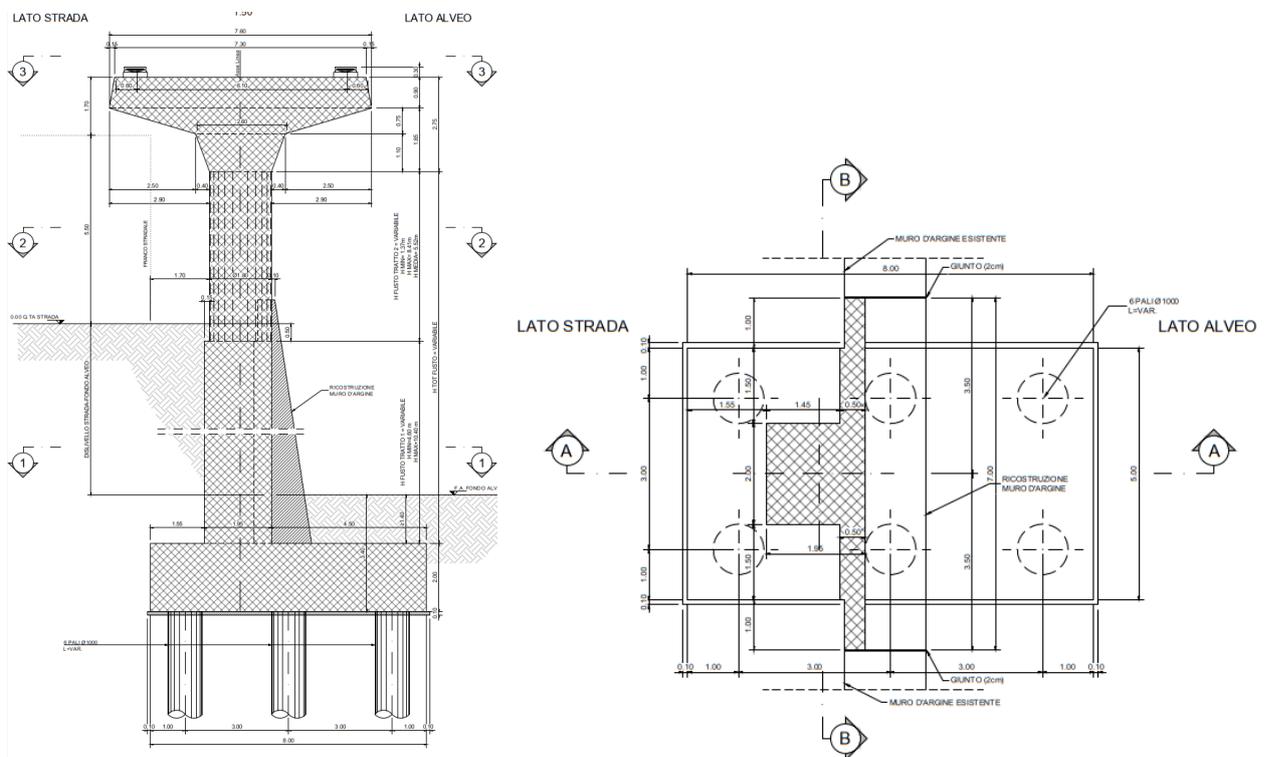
(sx) Pile lungo linea; (dx) Fondazione pila lungo linea.
